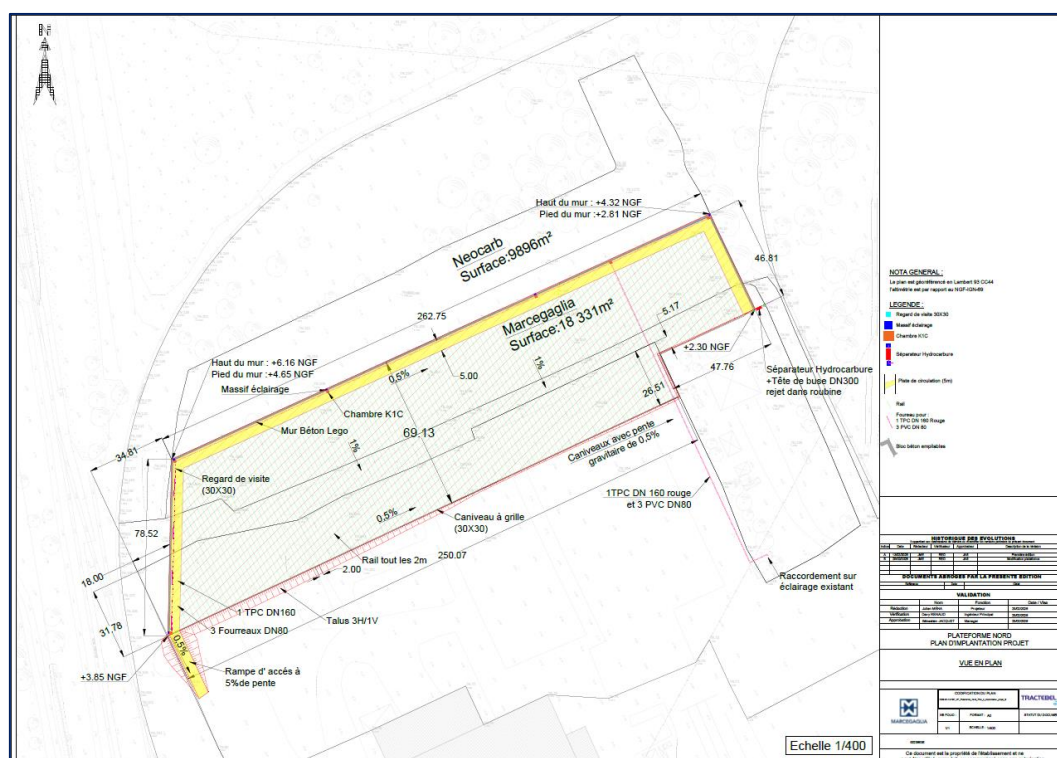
Plan d'implantation du projet de la plateforme Nord (source : Tractebel Engie)
